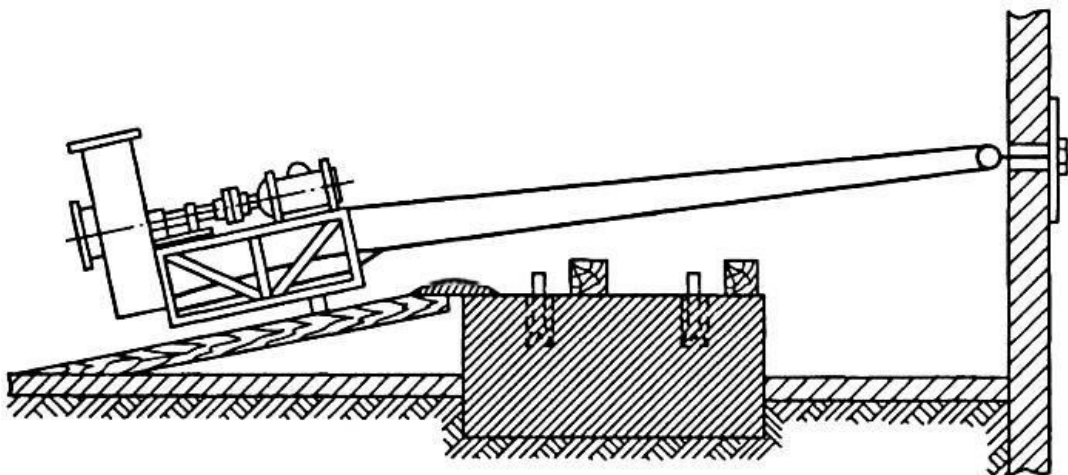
Схема установки вентиляторов на фундамент накаткой
